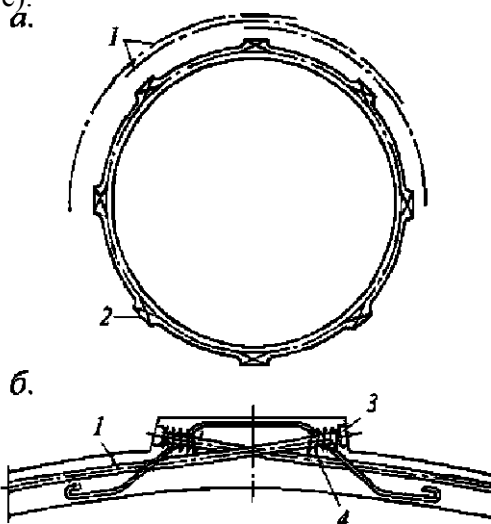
Армирование монолитных и сборных железобетонных куполов и их элементов
